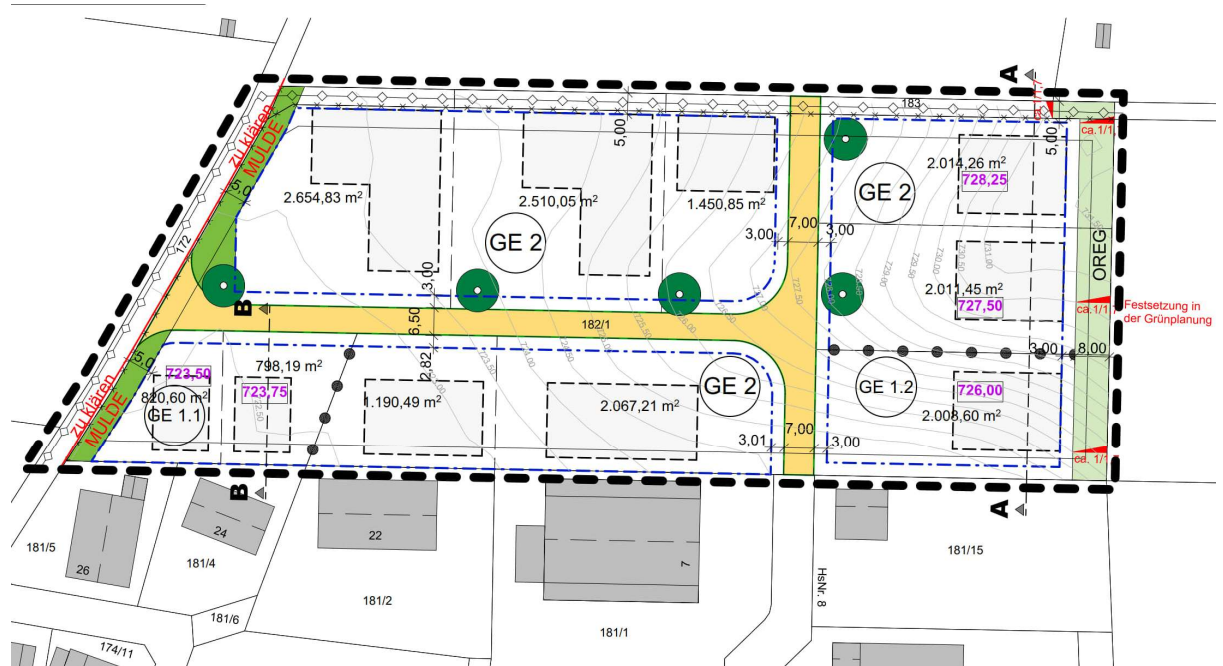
Planteil Bebauungsplan GE Höhenberg, gemäß [c]
